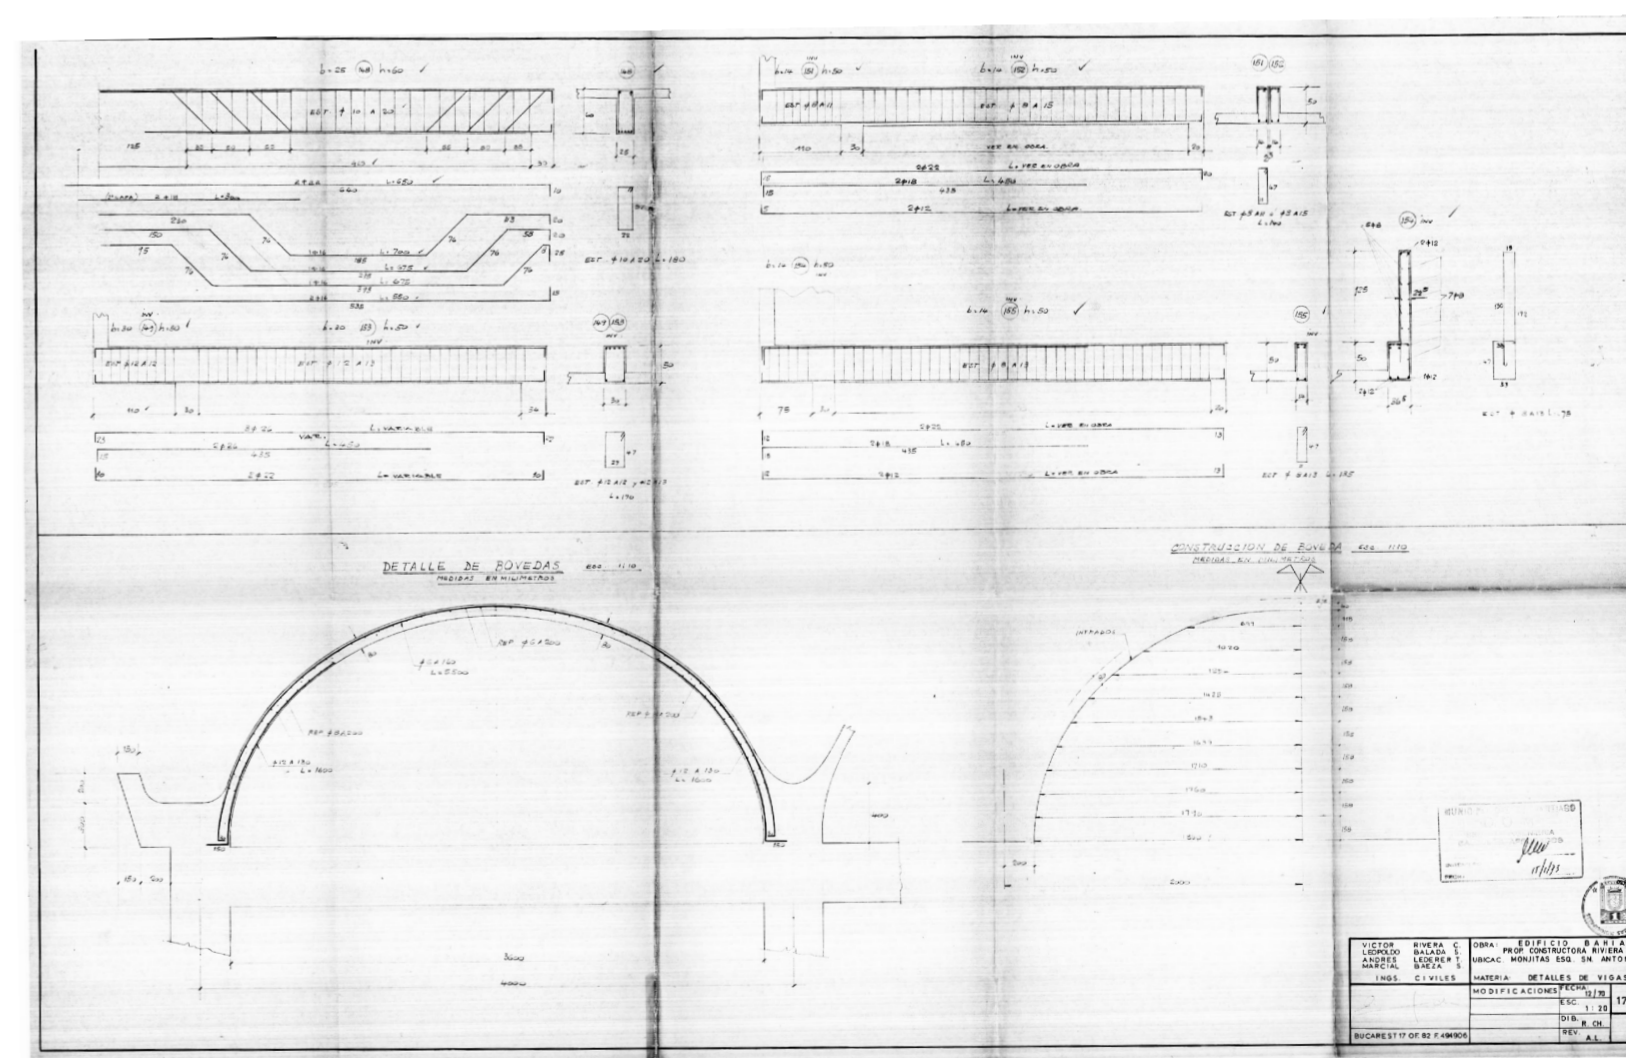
Archivo Plano Municipal. Detalles bóvedas.
